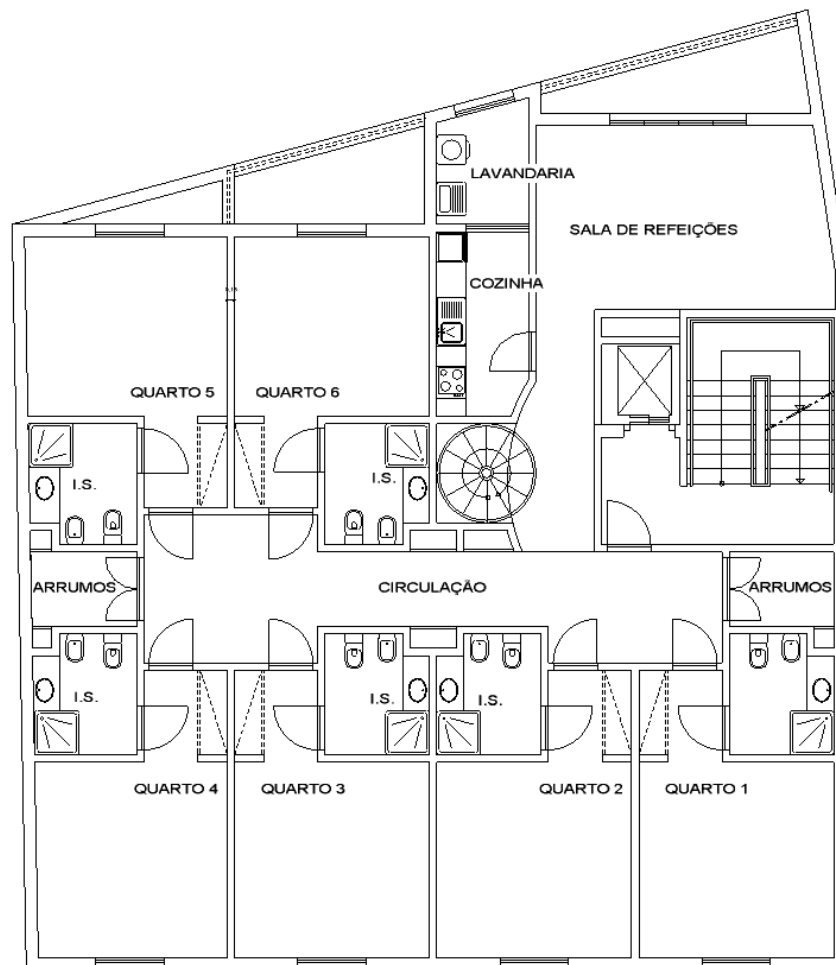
Planta arquitetónica dos pisos correntes [Plantas de arquitetura].
